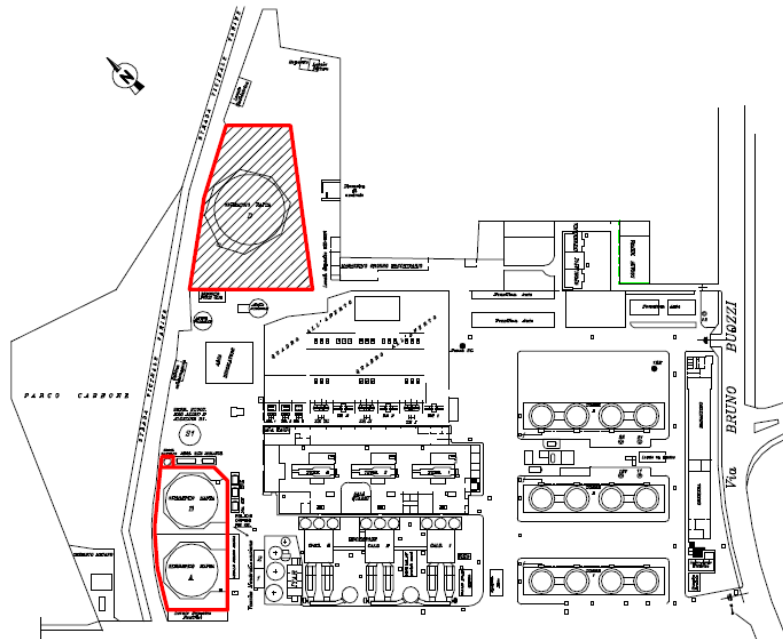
Planimetria di impianto ed ubicazione dei serbatoi di contenimento denominati A, B e D.
